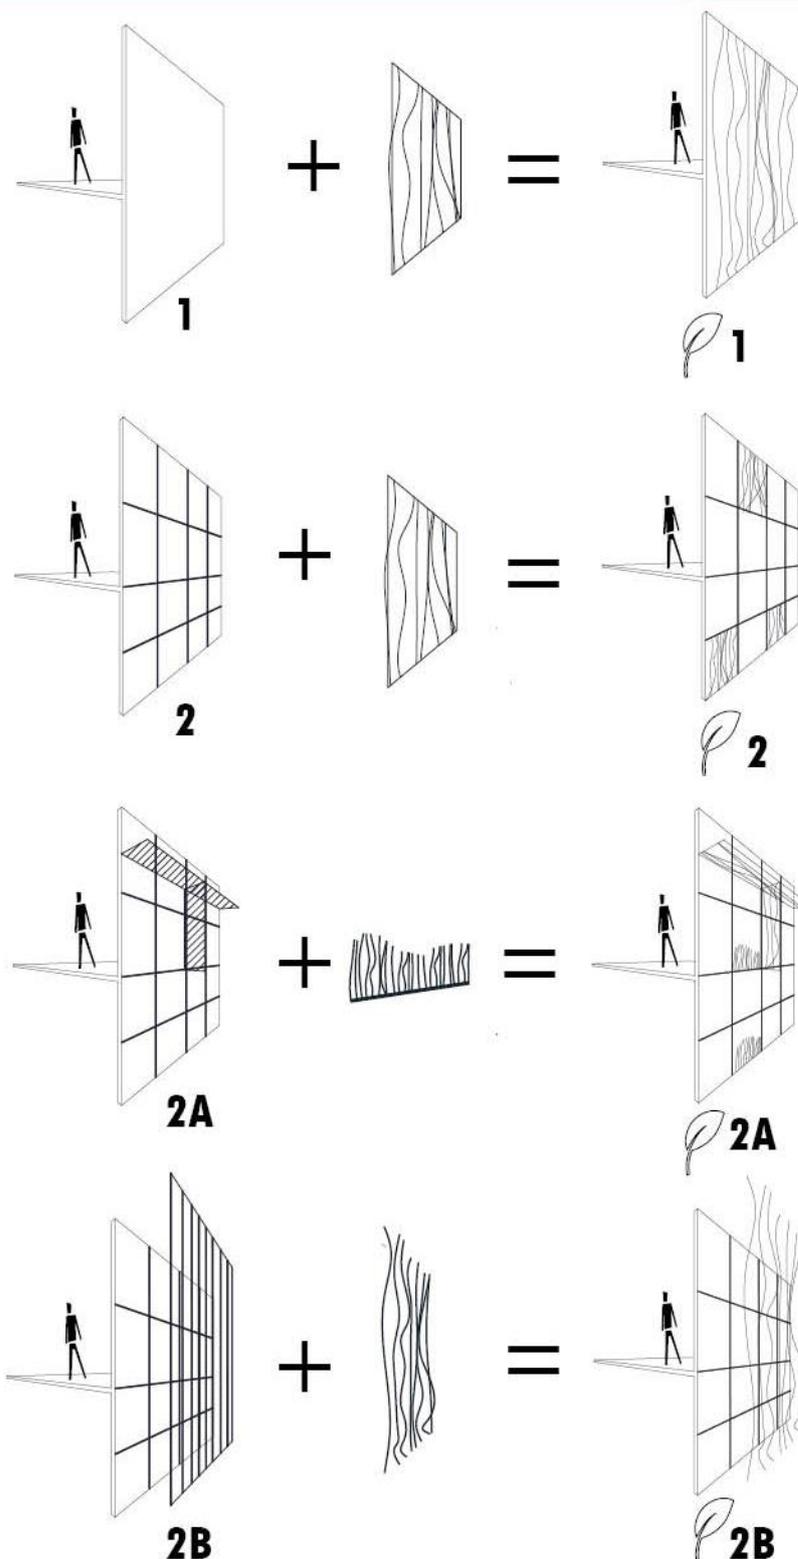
Fachadas não Habitáveis – camadas da envolvente construtiva – parte I
